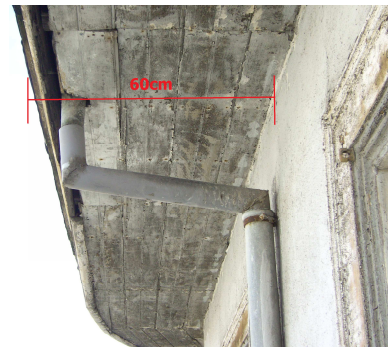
Vuelo de la cubierta sobre el balcón de la planta 3ª
